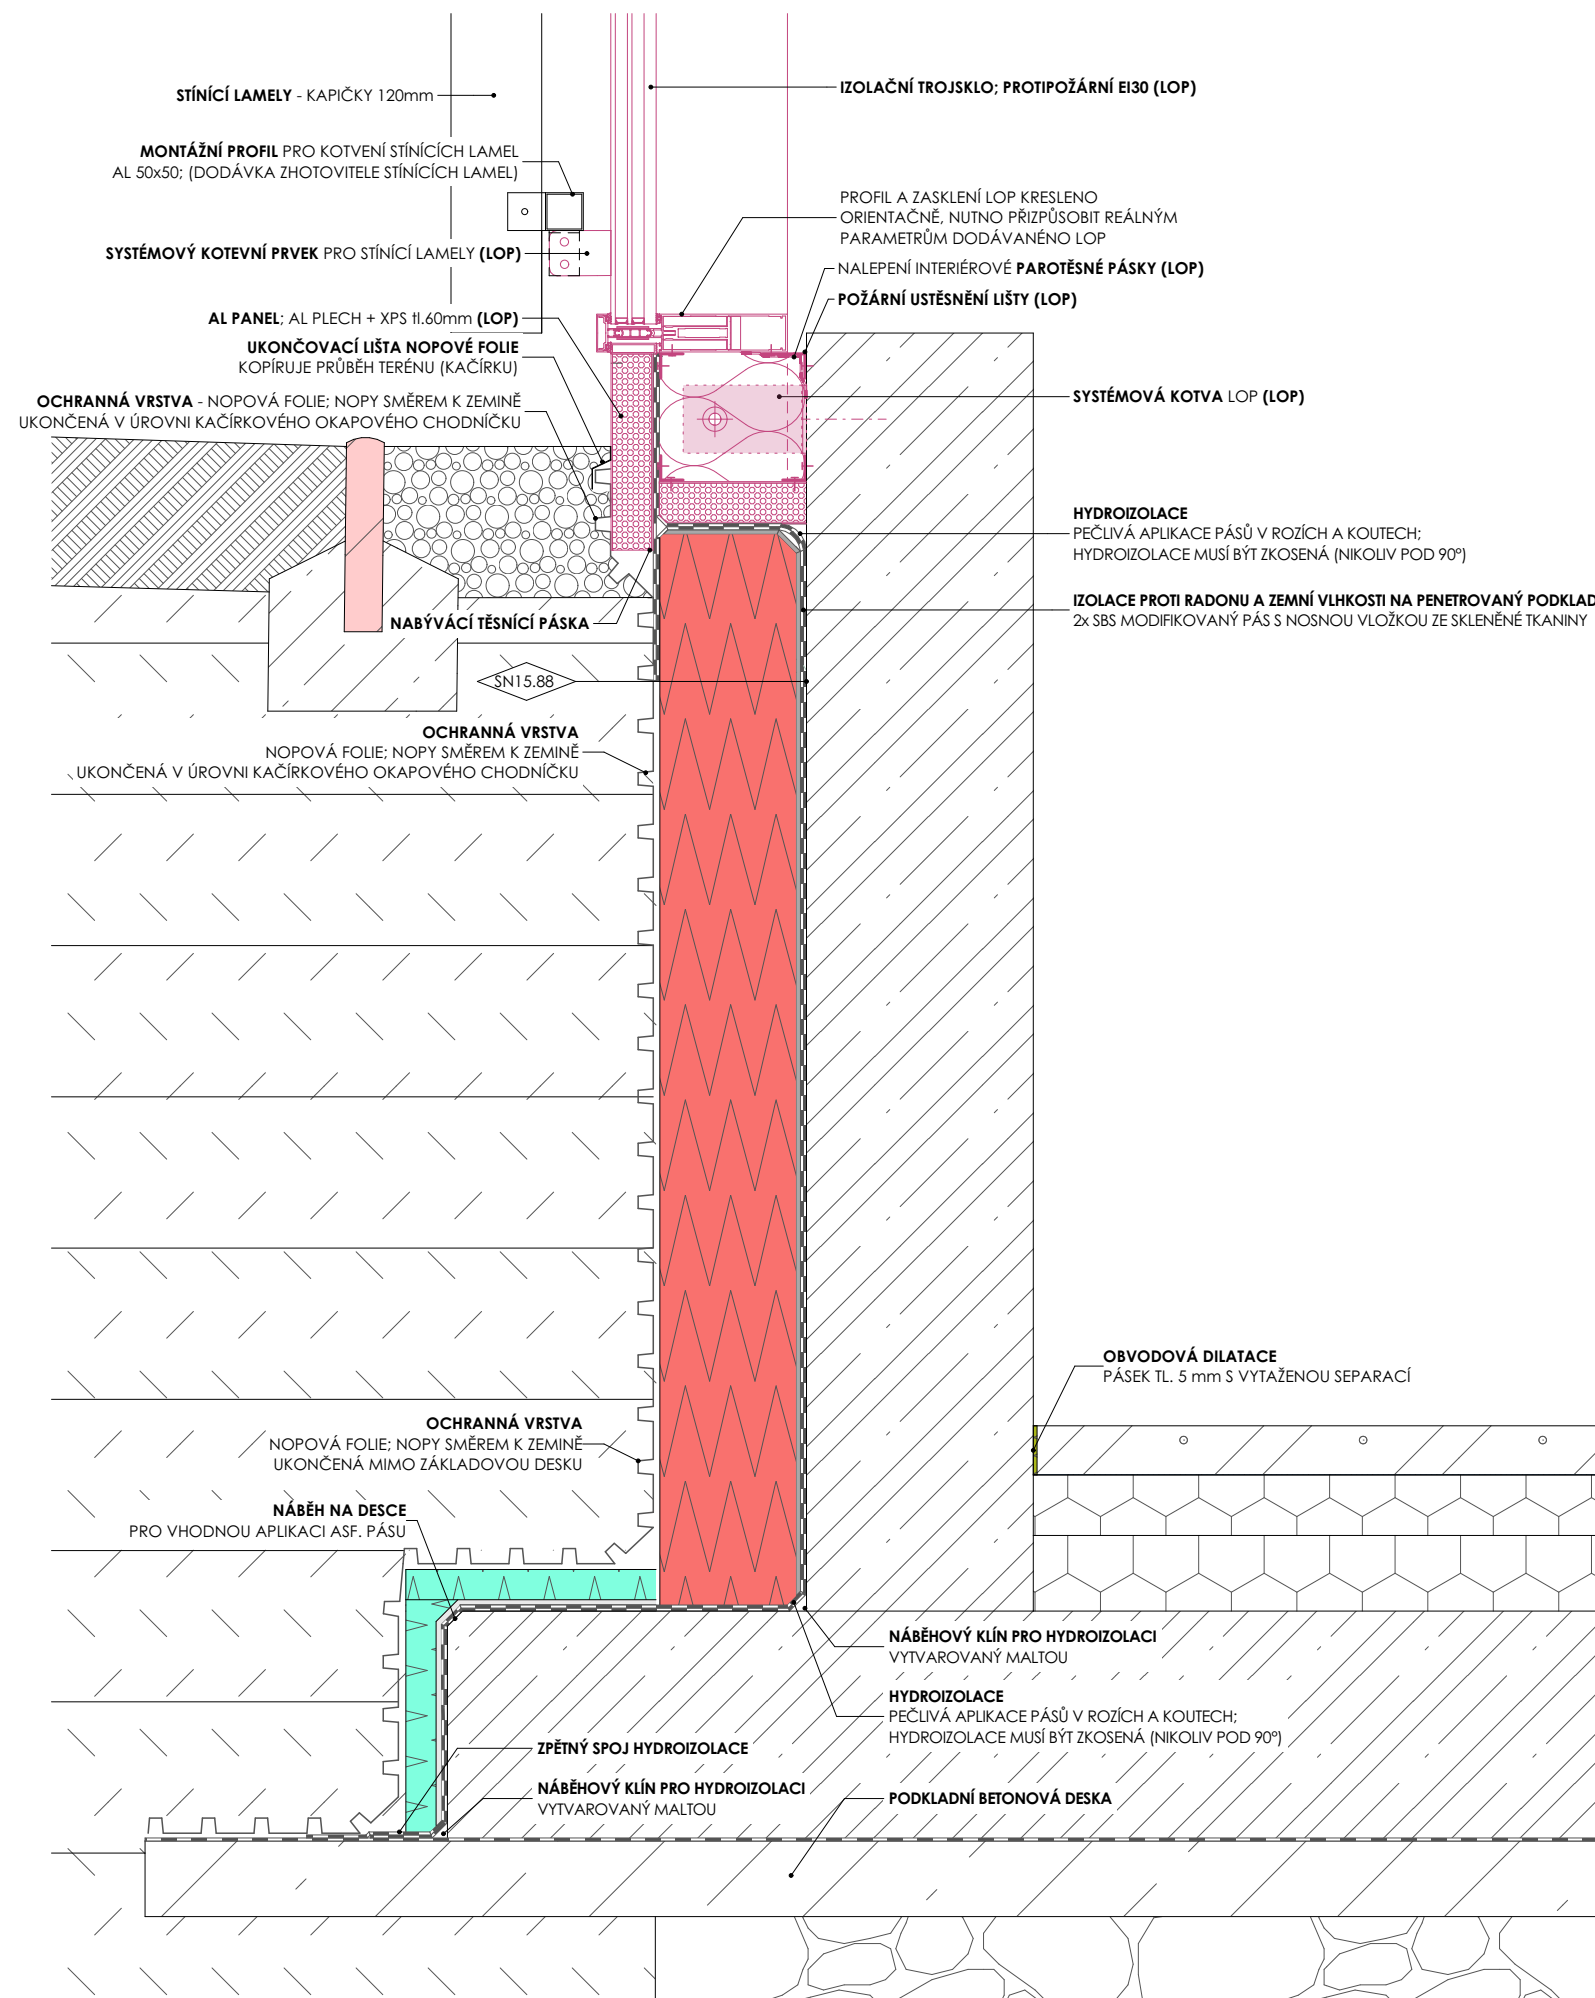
PŮDPRYS LOP - VÝTAH
